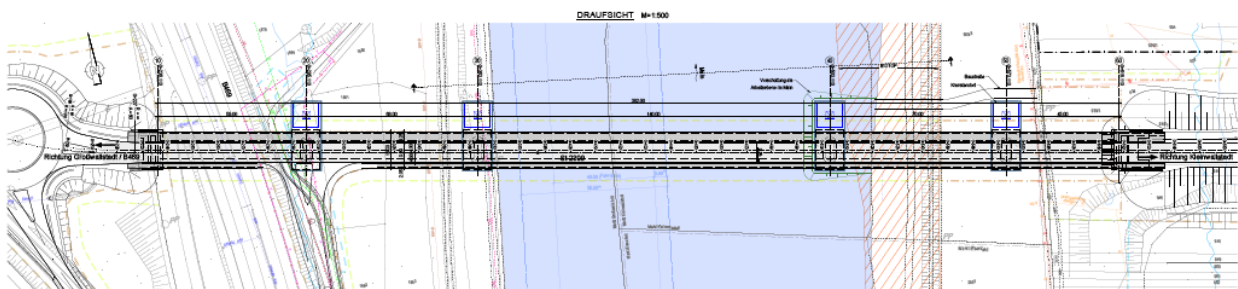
Lageplan Planung Stand 2024 (SRP)
